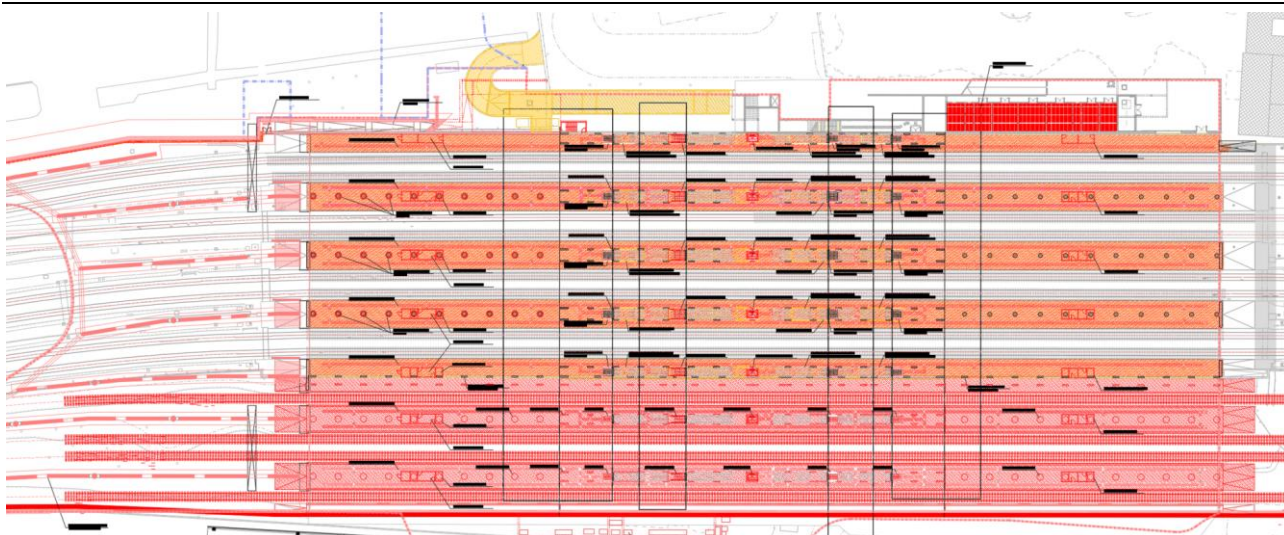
Planimetria demolizioni Piano Banchine Stazione di Bovisa (demolizioni in giallo)
